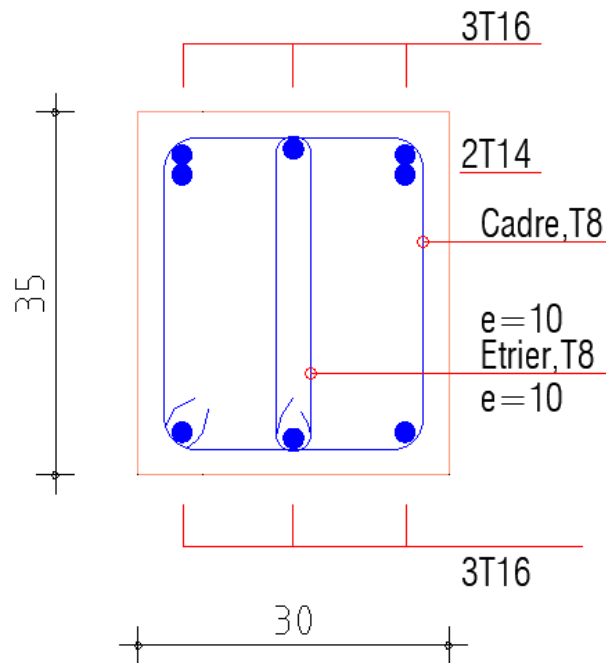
Ferrailage de poutre de chaînage RDC → terrasse (appui).
